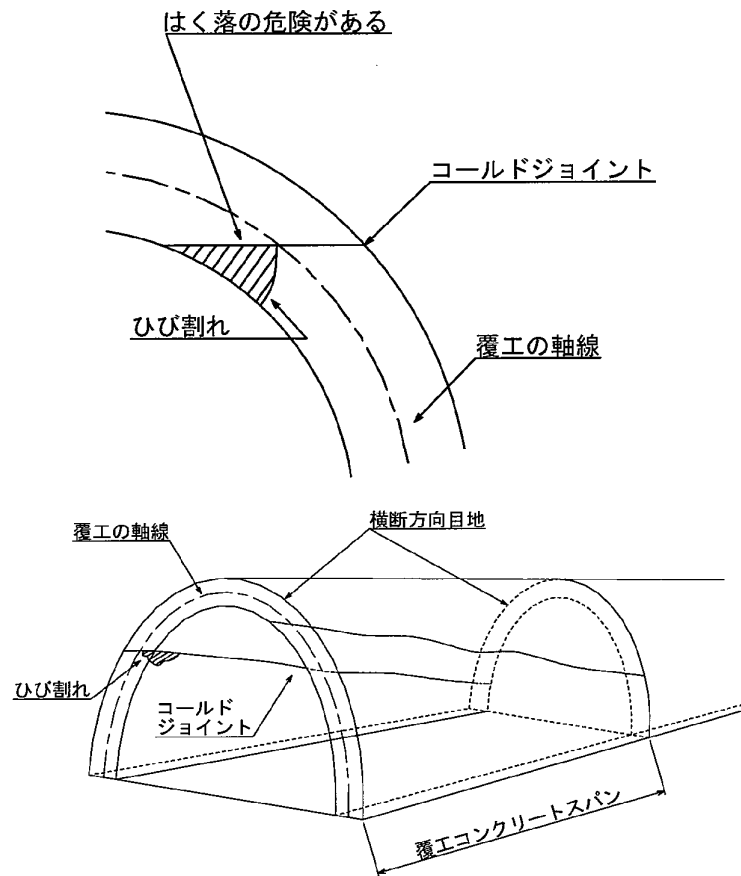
コールドジョイント付近に発生するひび割れの例
